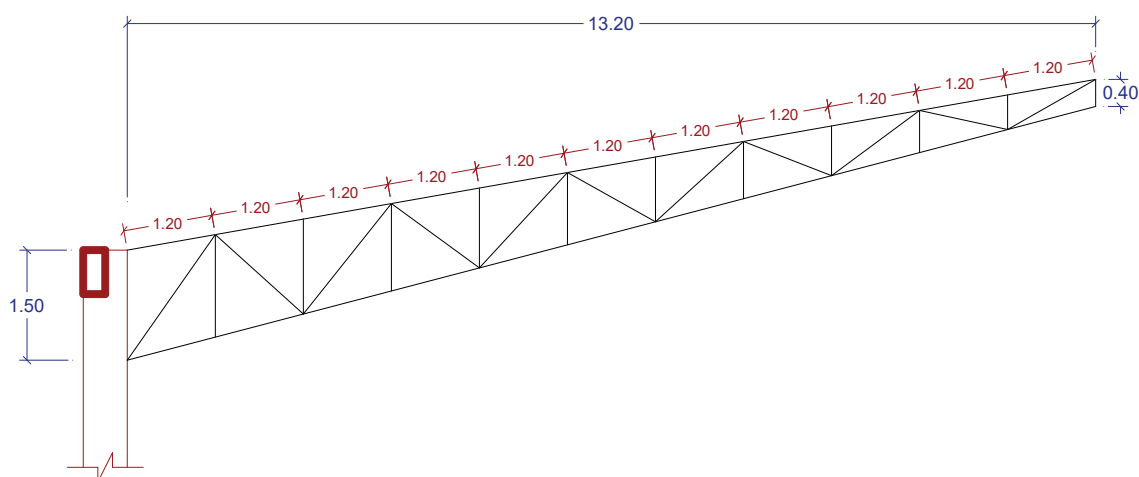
Vista transversal de Tijeral – Estructura Metálica
